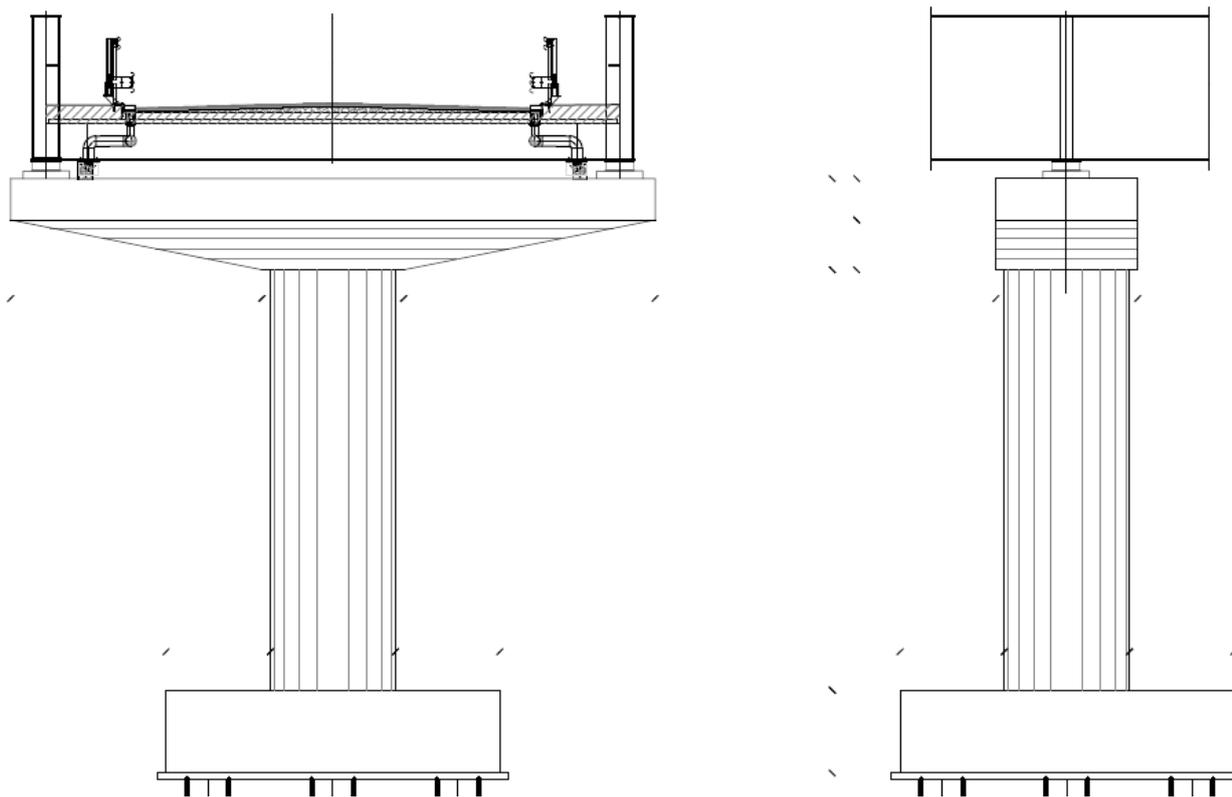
particolare progettuale composizione pilastro-pulvino trave
